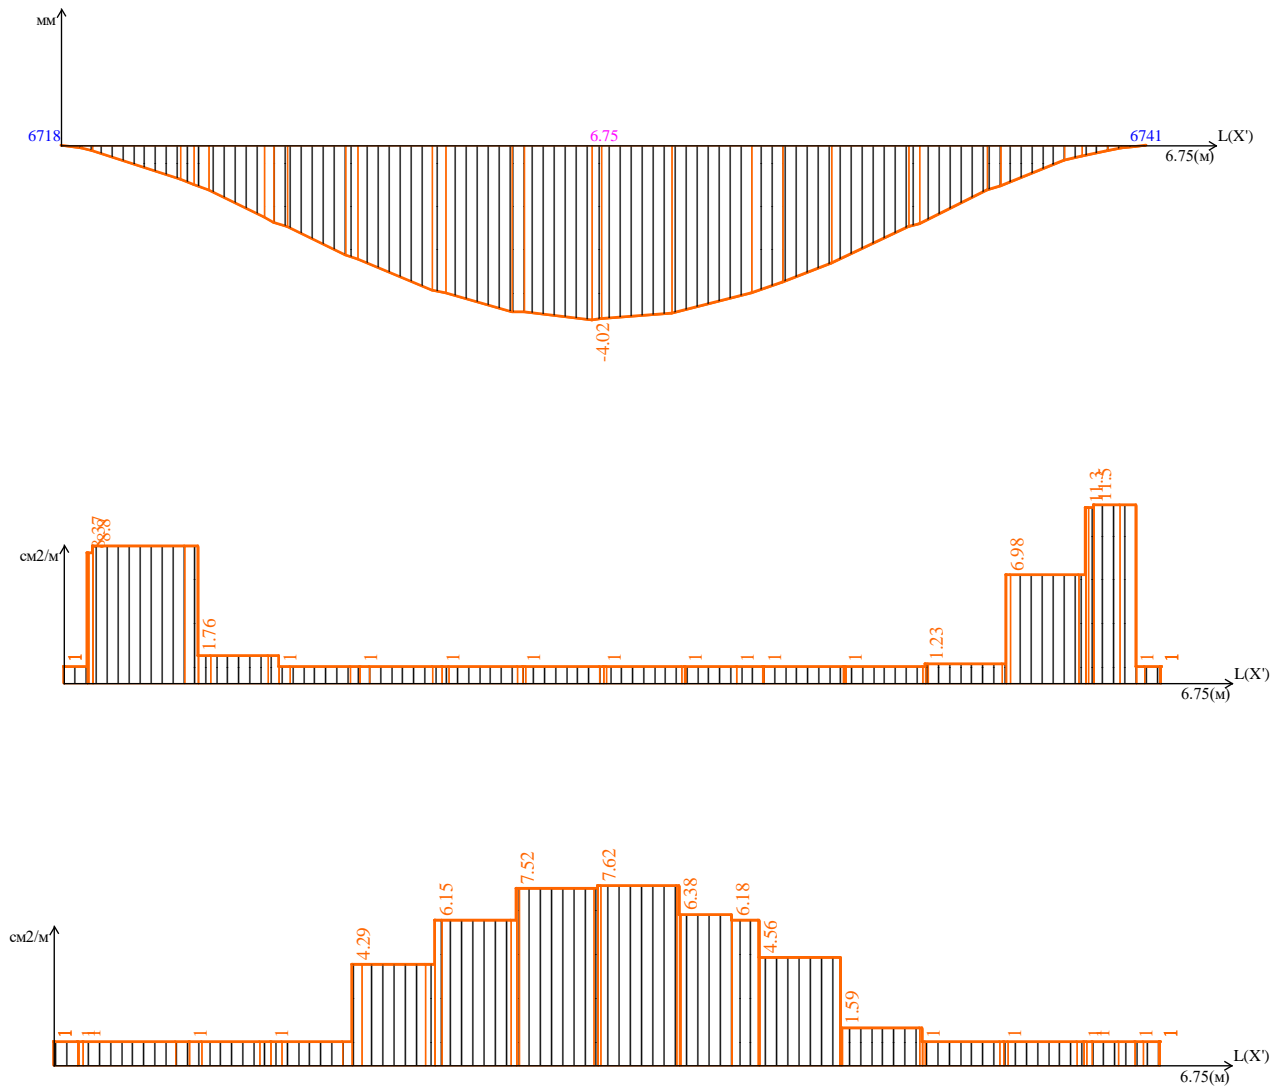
Прогиб перекрытия, верхнее и нижнее армирования в осях А-Б без дополнительных нагрузок
